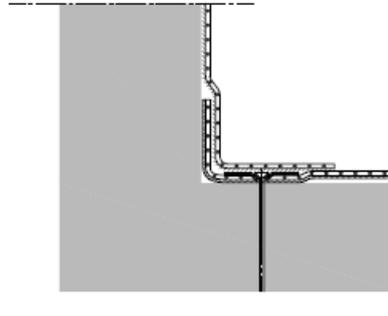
Anschlussabdichtung/ Befestigung mit Einzelbefestigungen
